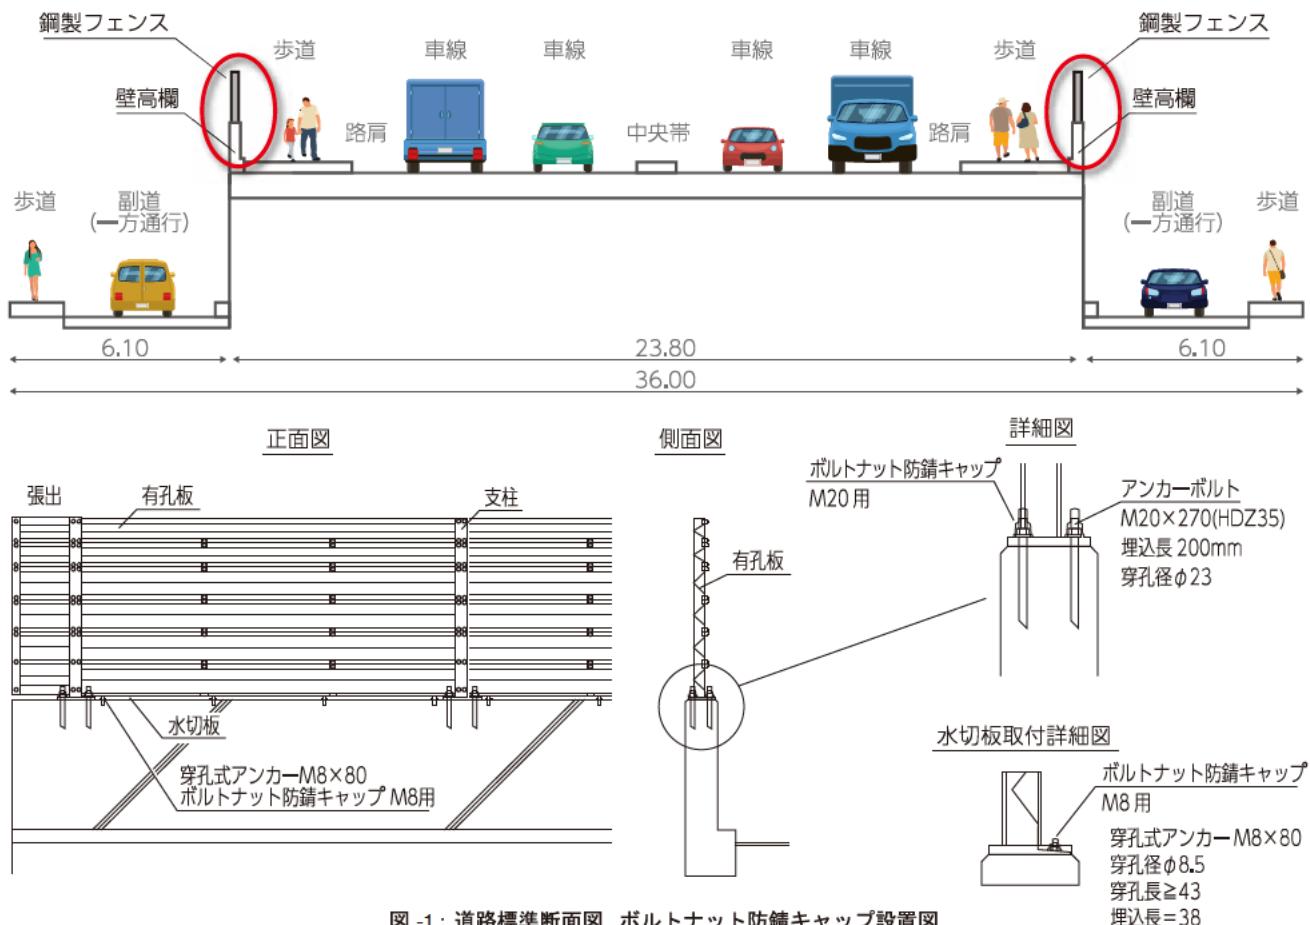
道路標準断面図、ボルトナット防錆キャップ設置図
